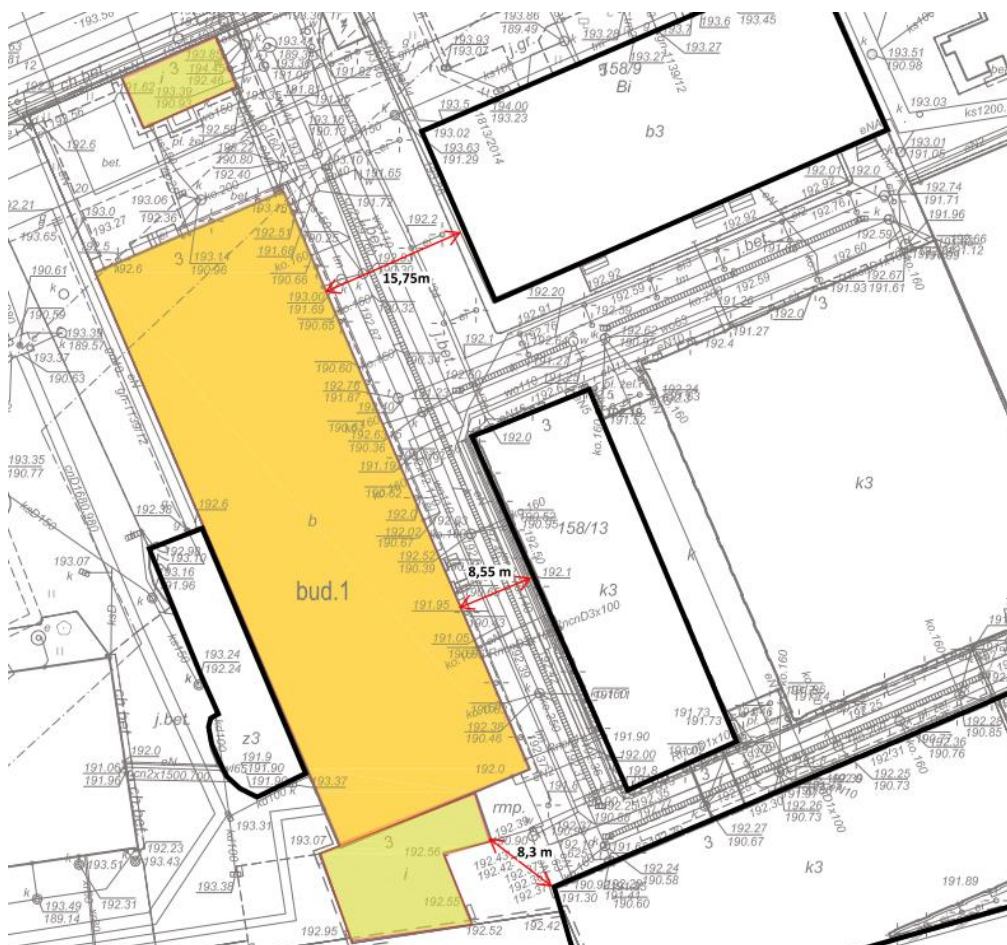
Rzut dachu budynku nr 1 – rozwiązanie zastępcze.
